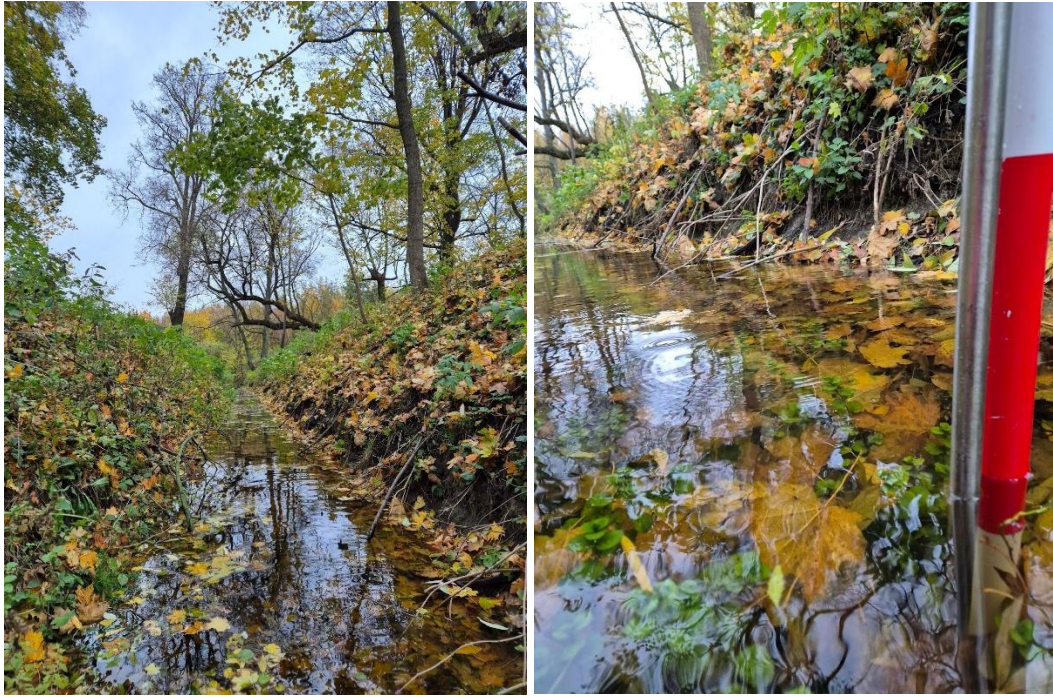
Widok na czasę zbiornika w kierunku zachodnim (fot. 28.10.2025)
